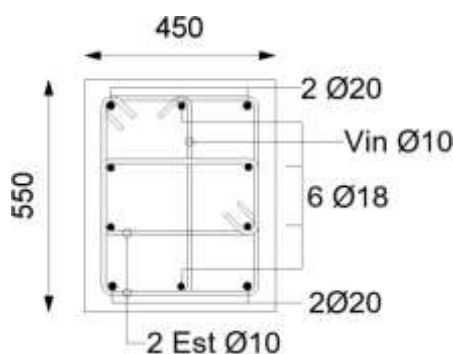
Sección transversal de la columna. [Elaboración propia]
